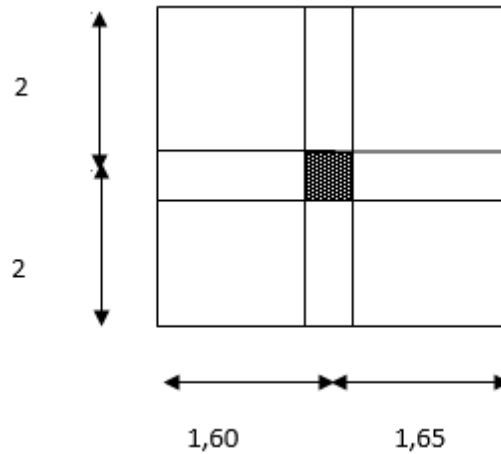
Surface du plancher revenant au poteau central le plus sollicité.
